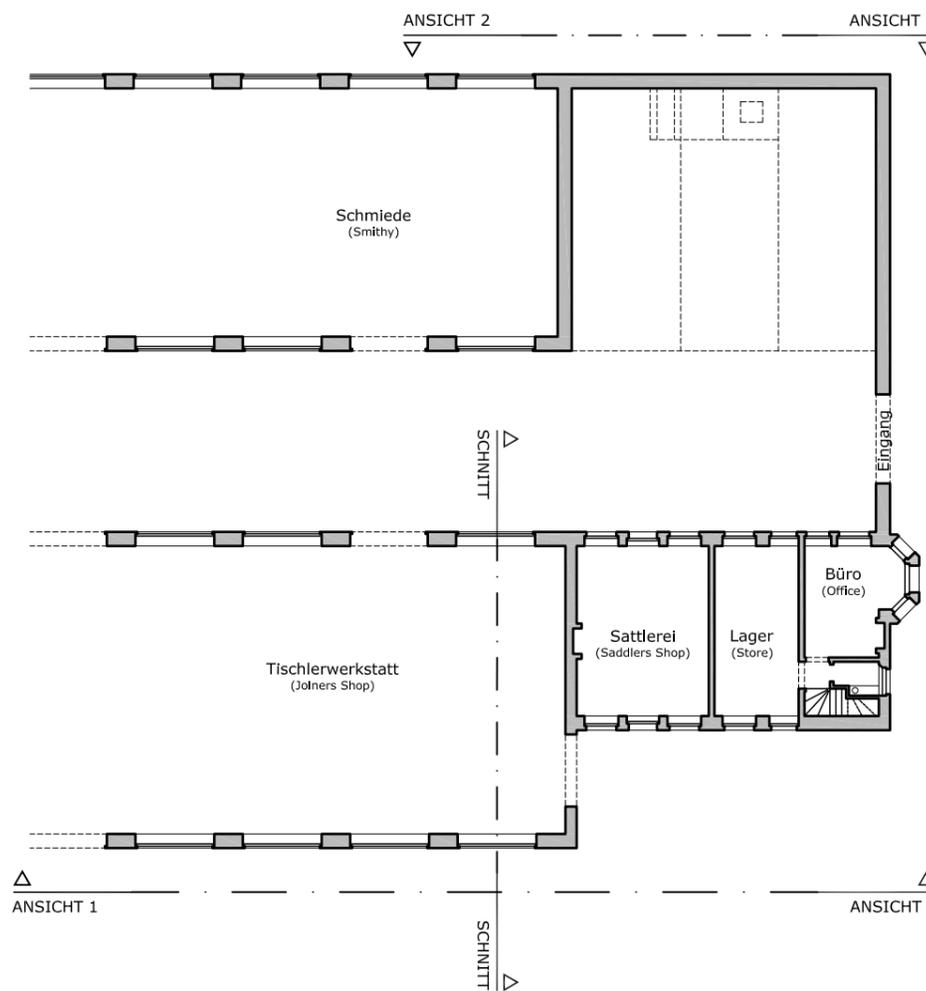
Grundriss - Neue Werkstätte Shrubhill
